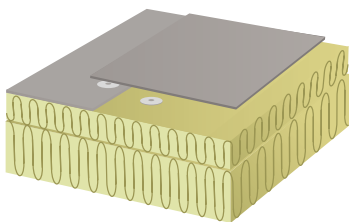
Крепление гидроизоляционной мембраны к покрытию
